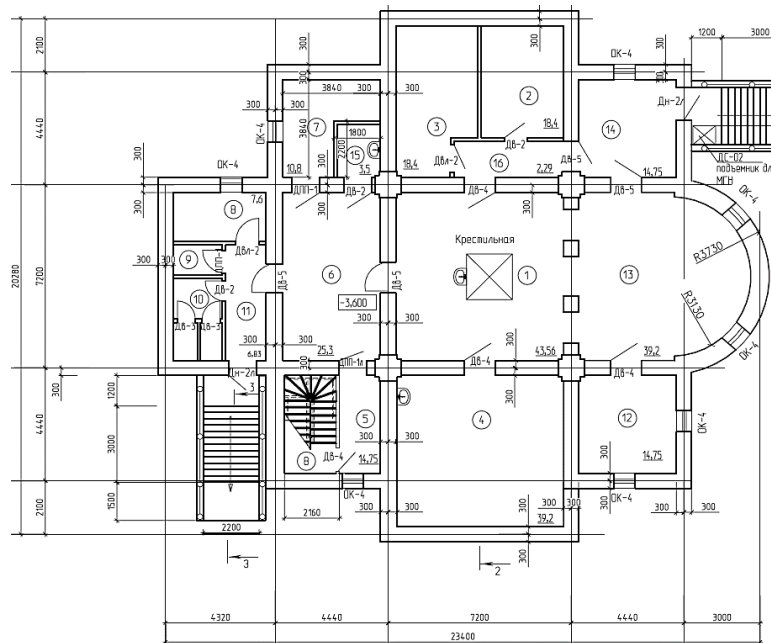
План подвала храма (данные ООО «Акватех+»)
